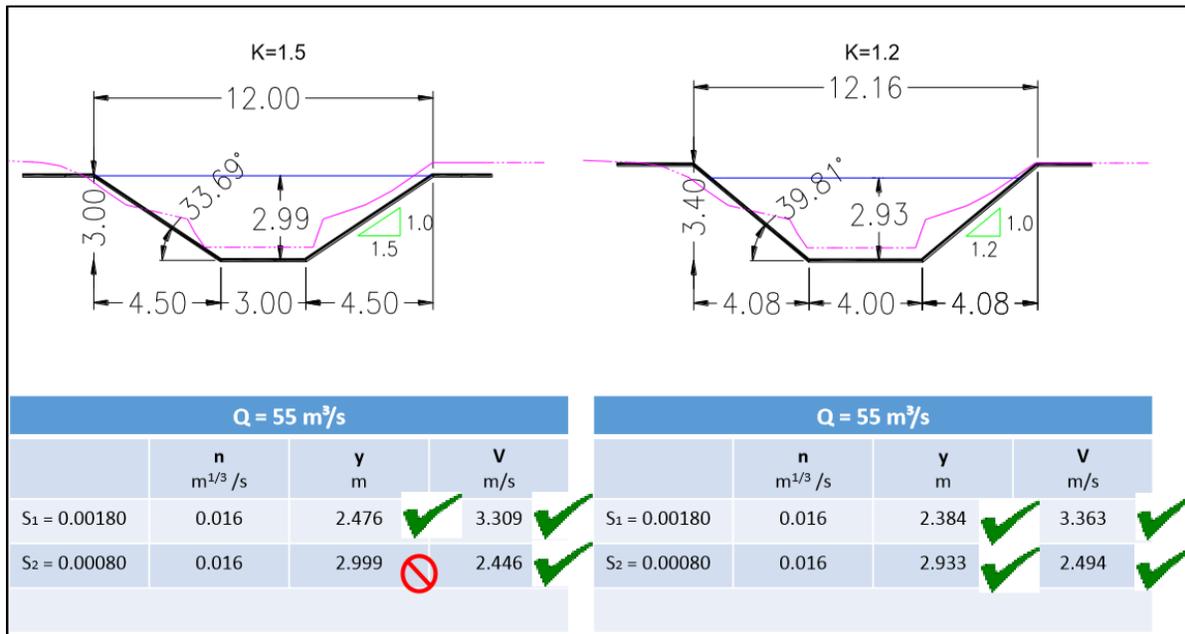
Opción 1 Sección de asfalto con fondo fijo (con plantilla de asfalto).
